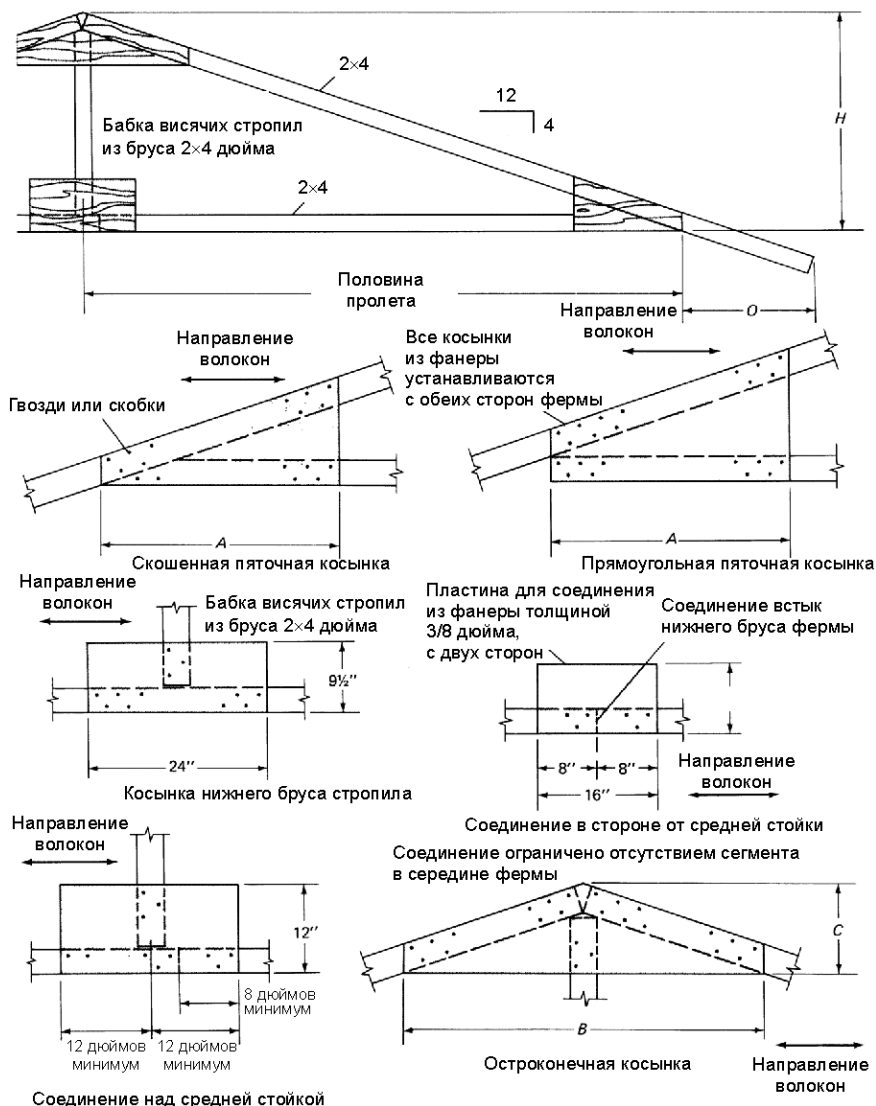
Конструкция фермы с бабкой висячих стропил
